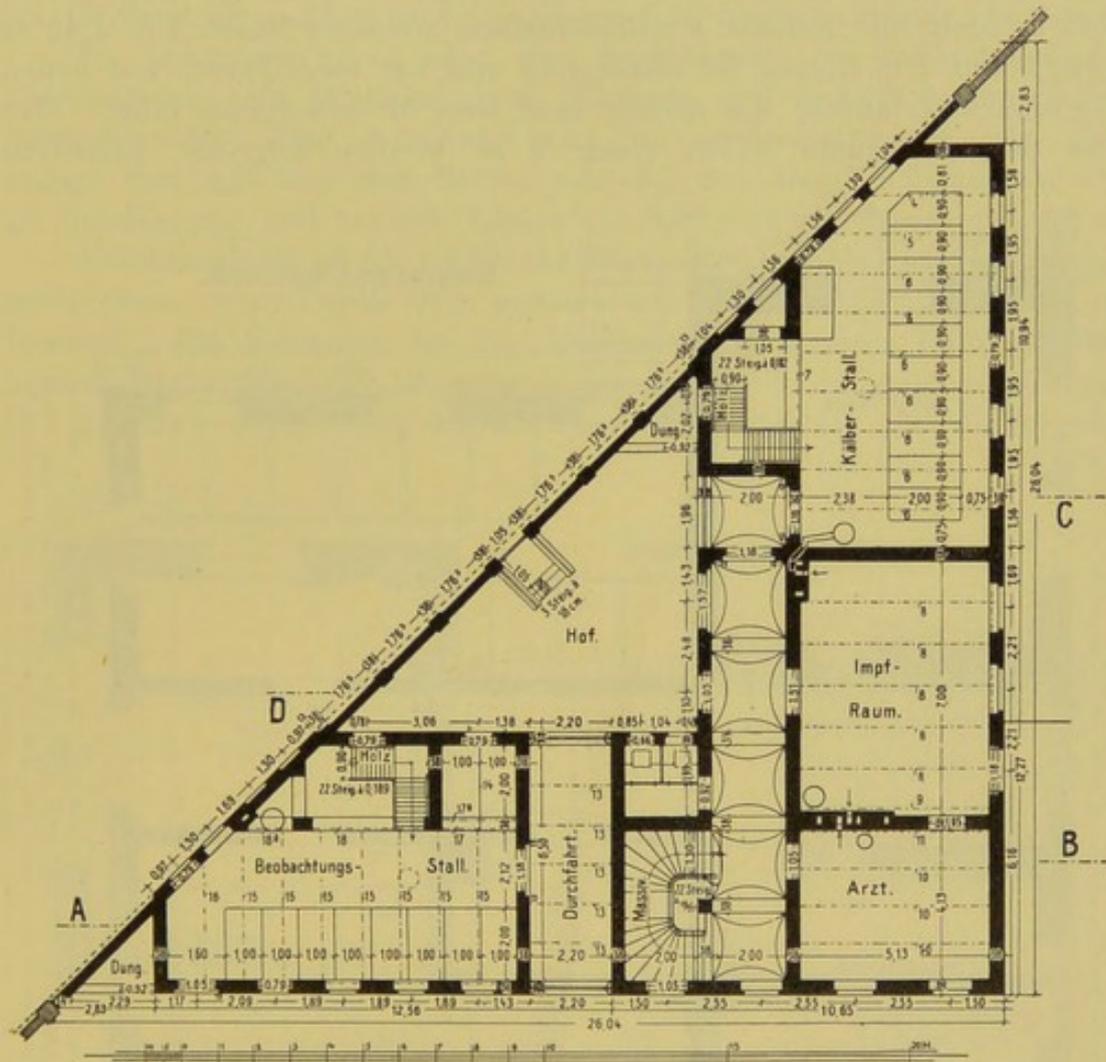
Impfanstalt in Berlin: Grundriß des Erdgeschosses.
